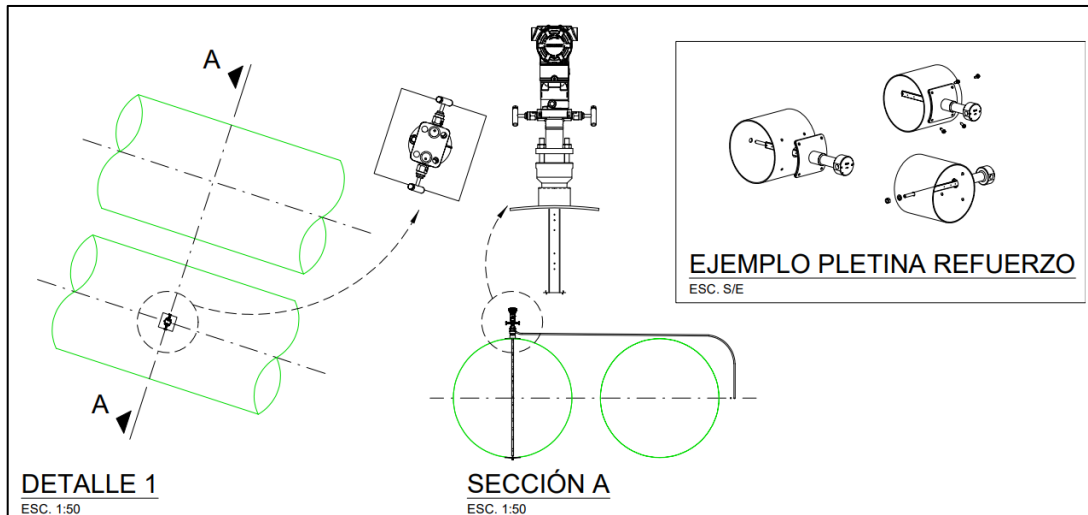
Detalle de soportado elementos primarios de caudal. Extraído de plano 062-IDG-DW-M-0670
